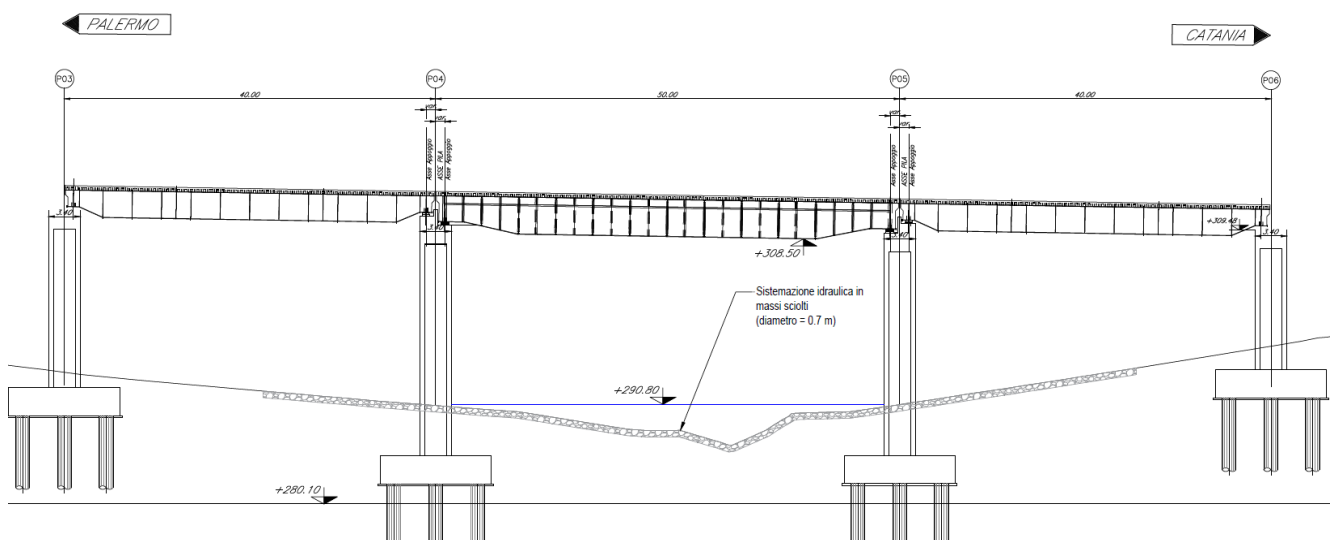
Viadotto VI04: sezione tipo delle opere di sistemazione idraulica.
